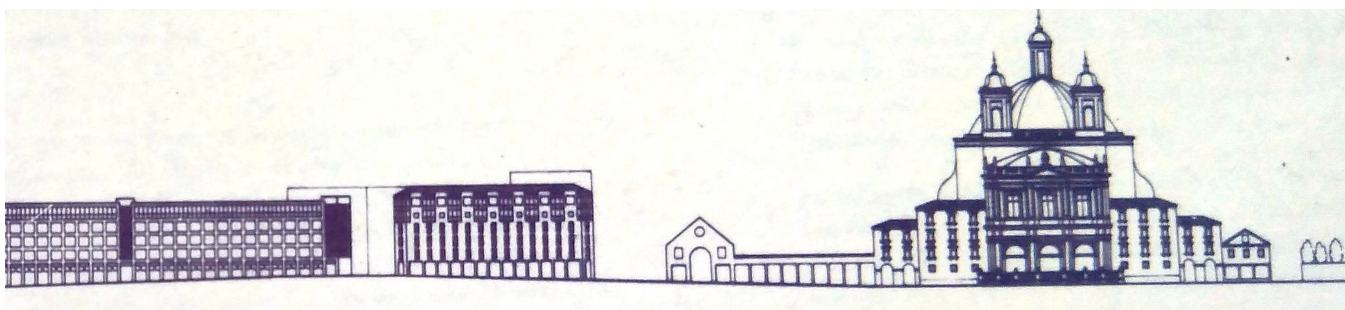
Alzado de la propuesta de Valdés y Gastelurrutia
